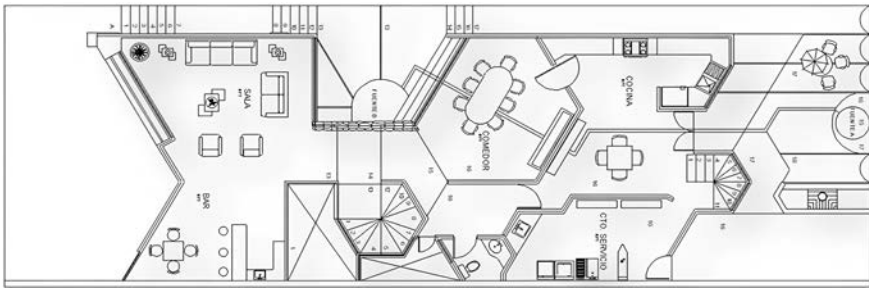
Planta arquitectónica del segundo nivel. Casa Z. A.
